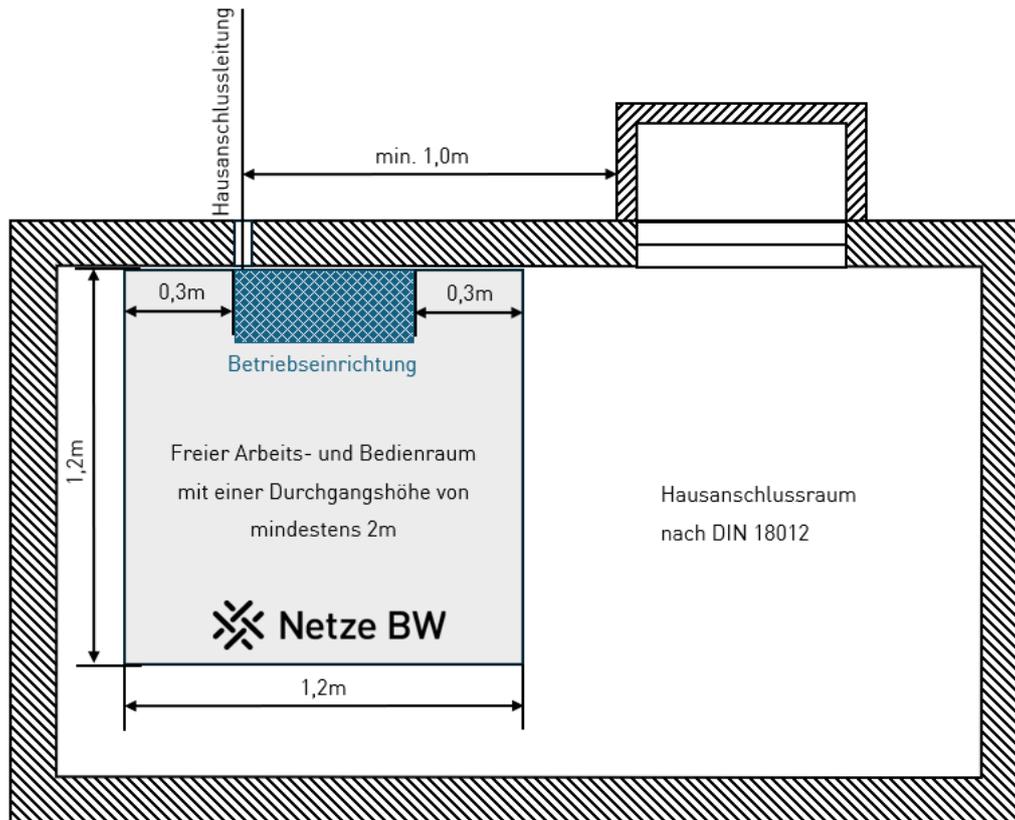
Hausanschlussraum mit Arbeits- und Bedienflächen
